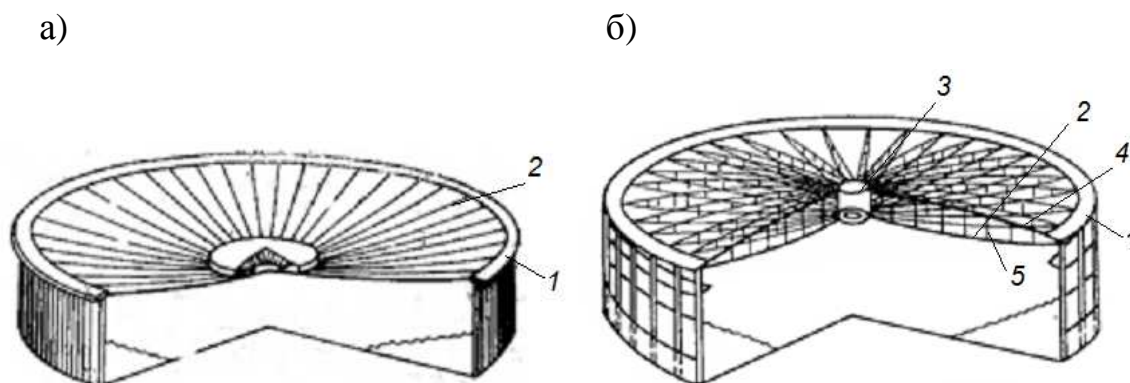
Пример вантовых конструкций с круглым планом здания;
